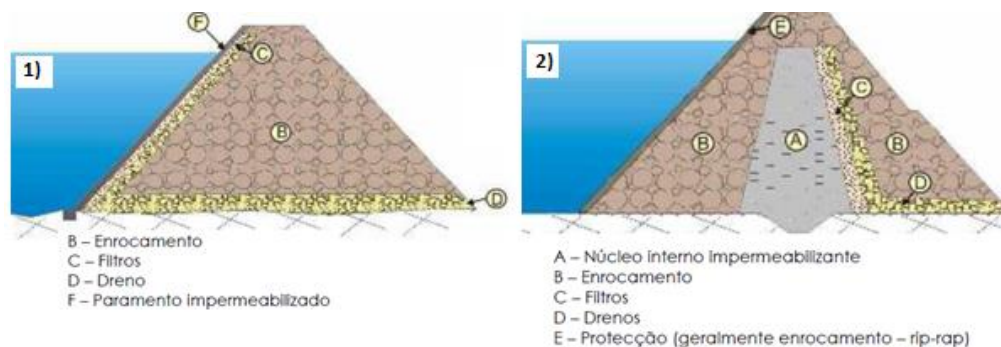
Barragem de aterro de enrocamento com: 1) cortina a montante 2) núcleo impermeável
